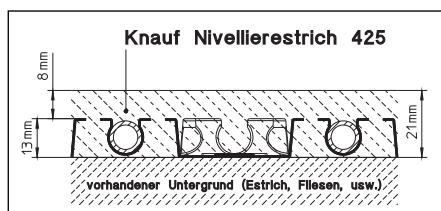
Knauf Nivellierestrich 425 (Mindestüberdeckung 8 mm, Gesamtaufbauhöhe 21 mm)
